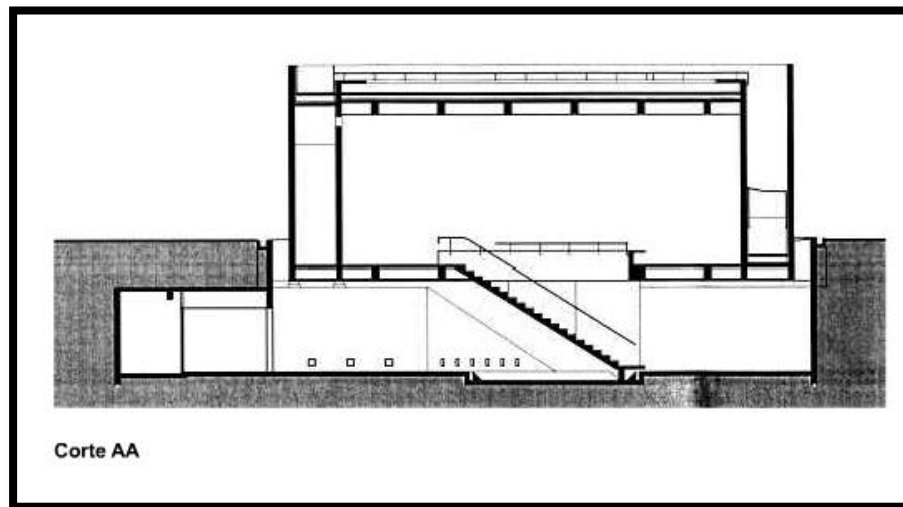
Corte transversal da Galeria de Arte Adriana Varejão, mostra parte da edificação semienterrado e pé direito no primeiro pavimento, neste contem grande obra da artista
